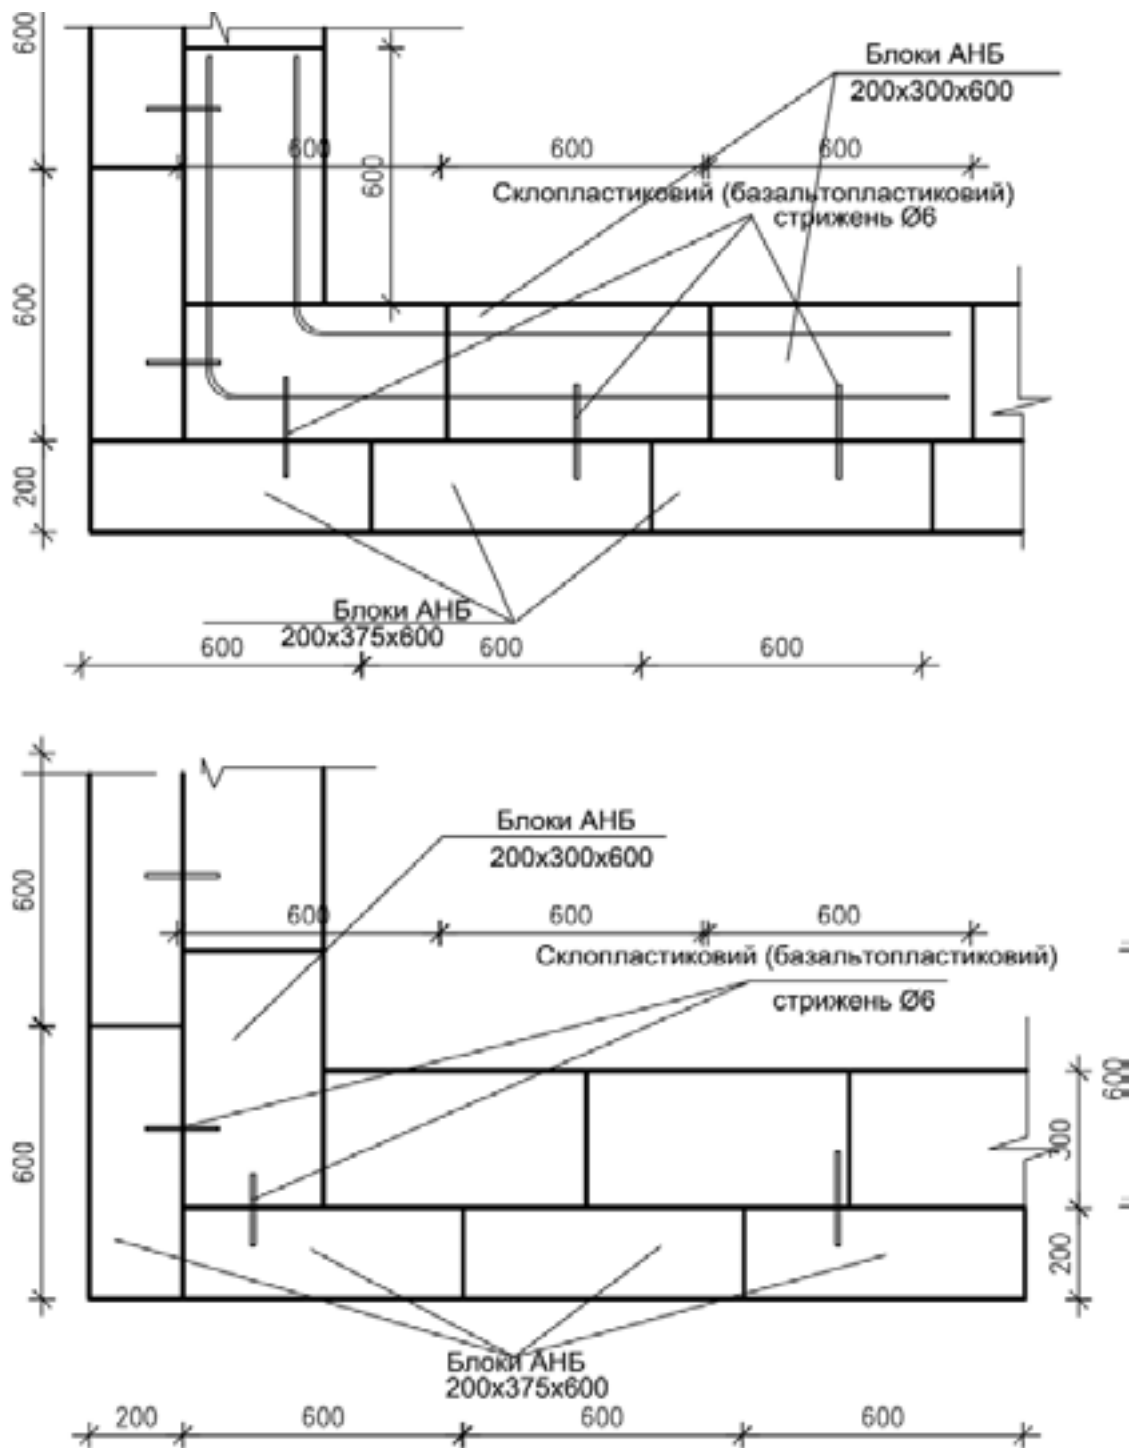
Двошарова стіна першого типу. Фрагмент глухої стіни. Угол кладки
